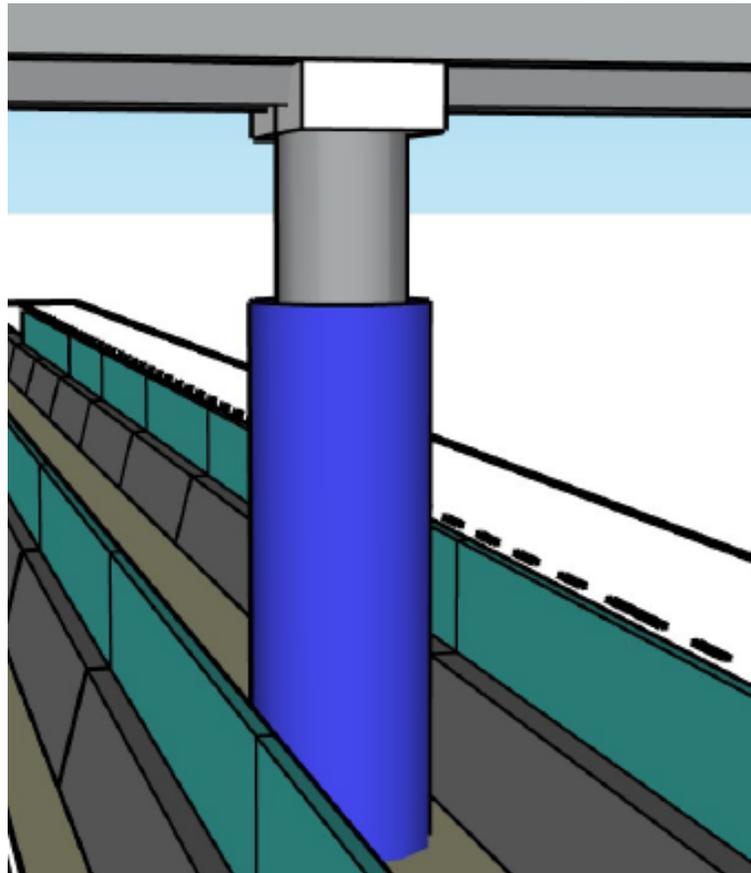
Pilar central con sección aumentada y barreras de contención.
